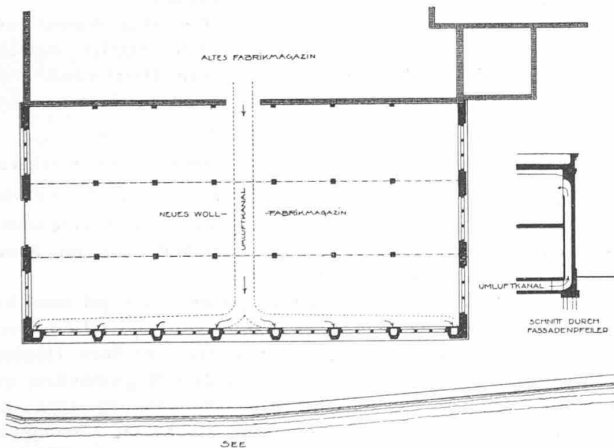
Erdgeschoss-Grundriss und Schnitt. — 1:500.
